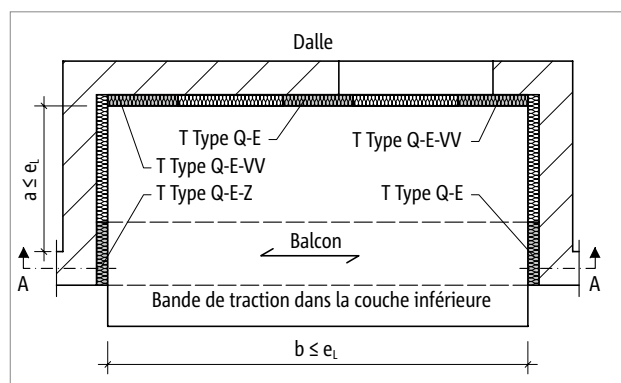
Schöck Isokorb® T Type Q-E-Z, Q-E : Plan de base loggia
